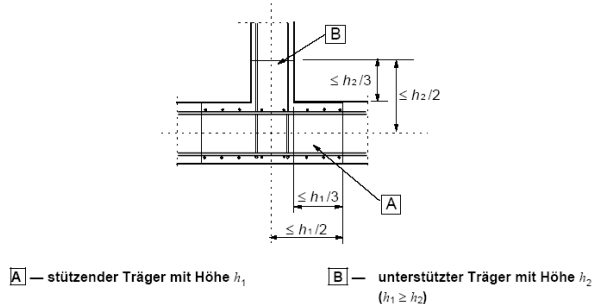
Bereich der Aufhängebewehrung beim Anschluss eines Nebenträgers (Grundriss)
